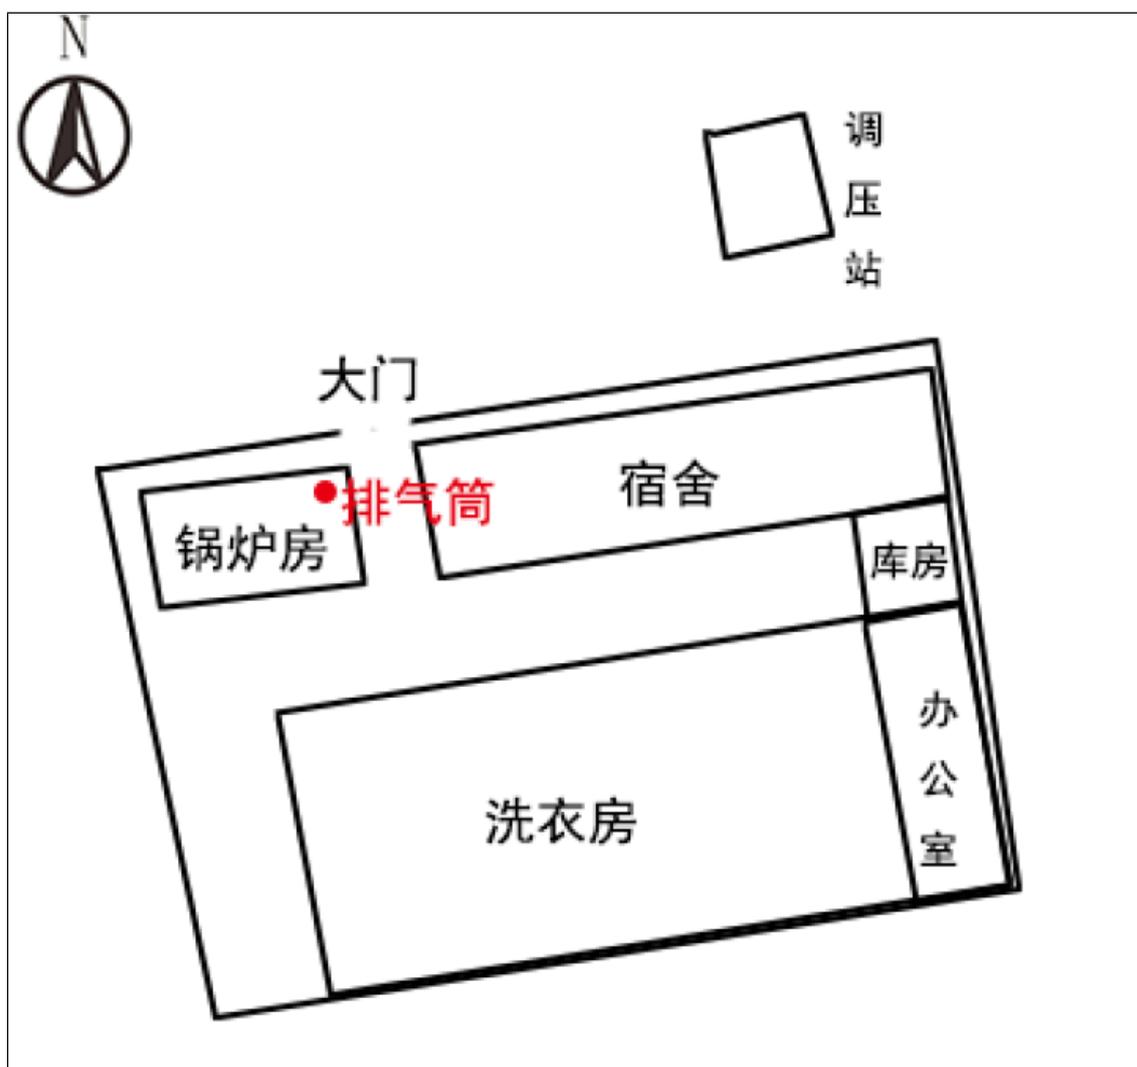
丽美净轩（北京）洗染服务有限公司厂区总平面布置图
